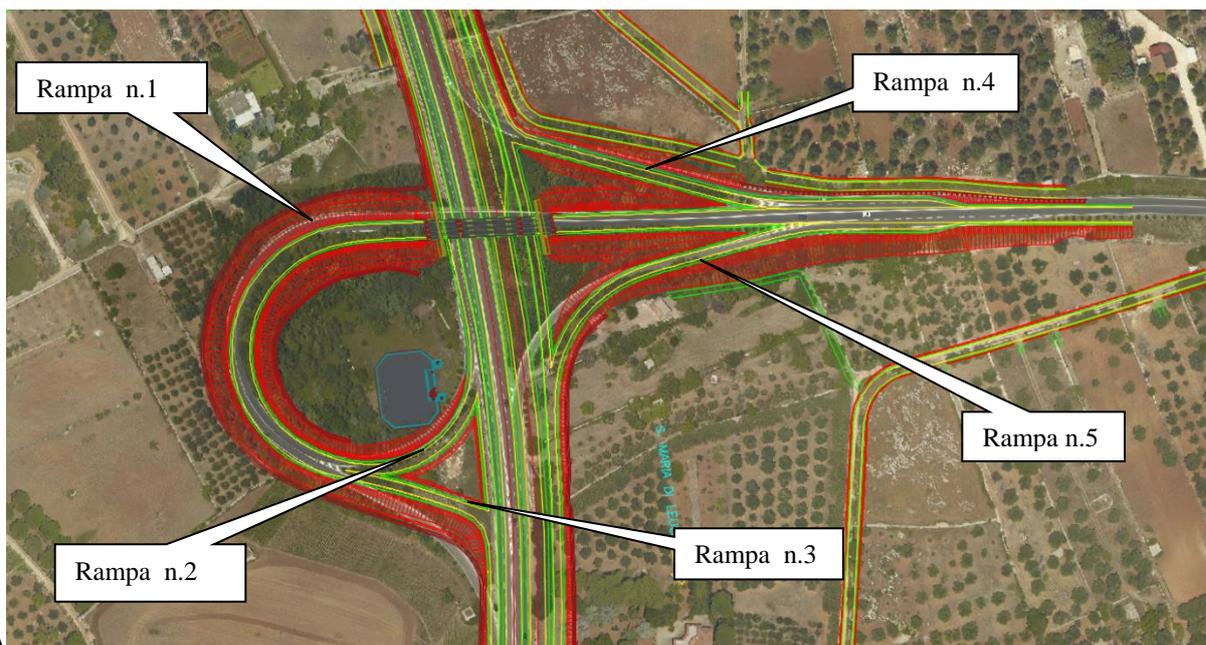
Svincolo 4 - SANTA CESAREA TERME – configurazione di progetto
